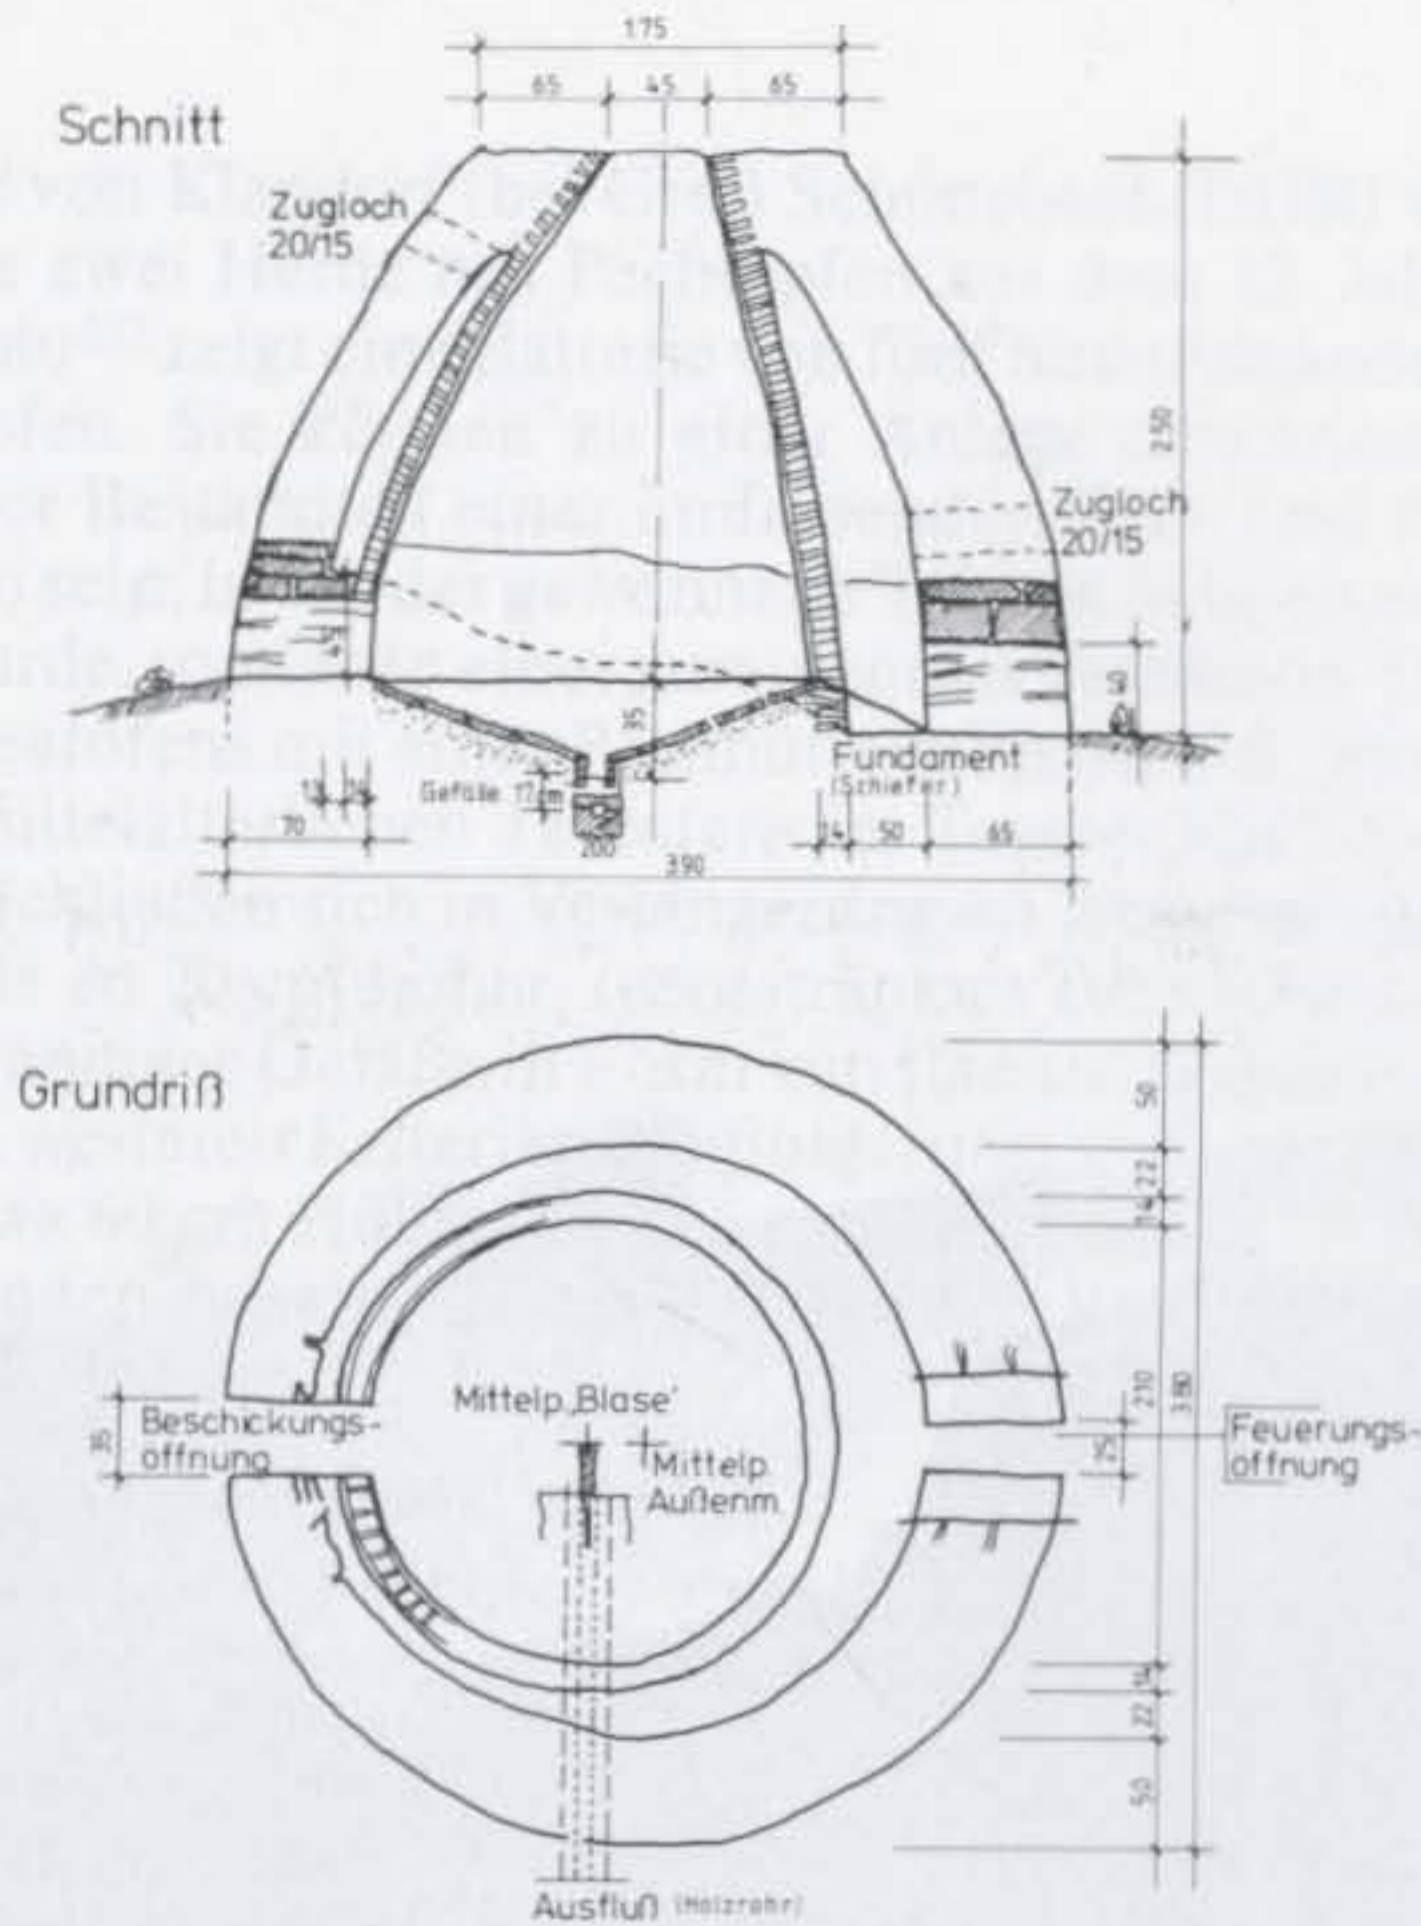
Aufriß und Grundriß des Teerofens von Eschbach (Stadt Usingen) nach Baeumerth (nach Ernst, Abb. S. 13)
